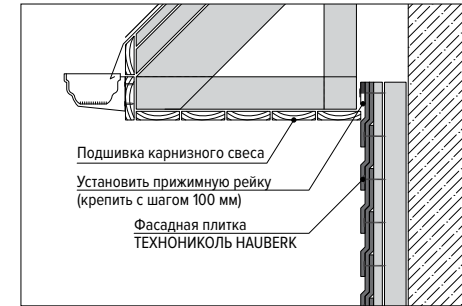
Монтаж верхнего ряда под карнизным свесом
